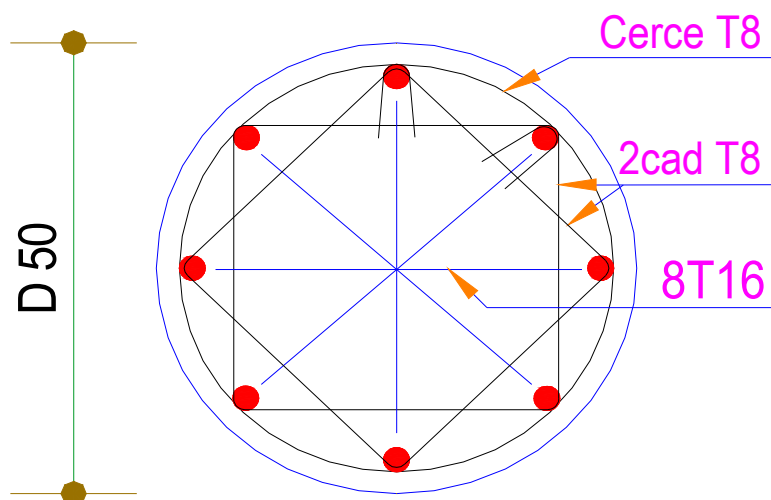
Schéma de ferrailage des poteaux dans chaque niveau
